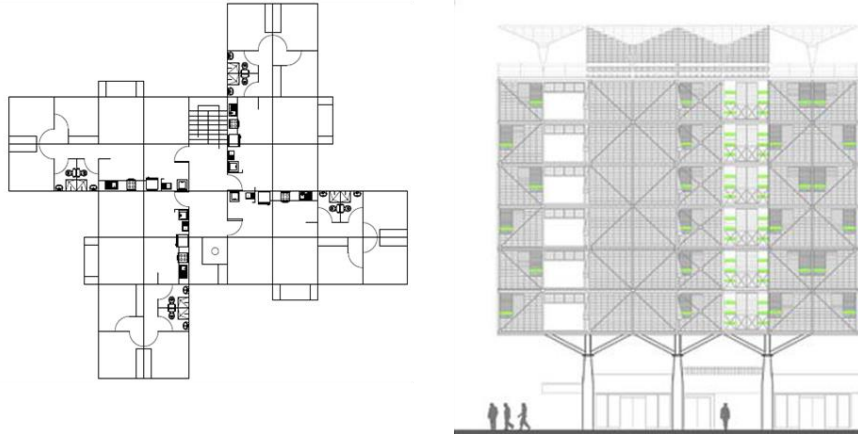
Planta Arquitectónica/ Vista fachada lateral
